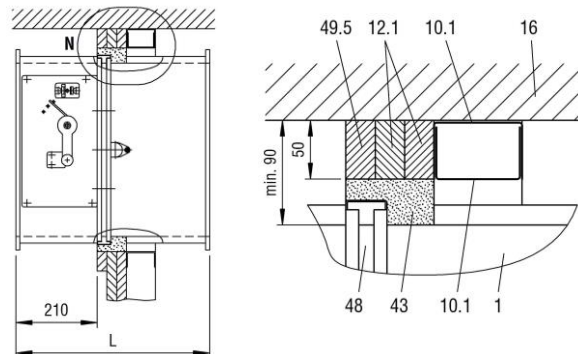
pannellatura parete e doppiatura direttamente sotto soffitto massiccio (parete pozzetto)
